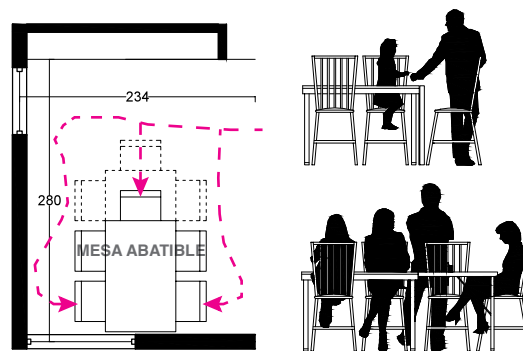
Planta de distribución de las habitaciones en Propuesta de viviendas
